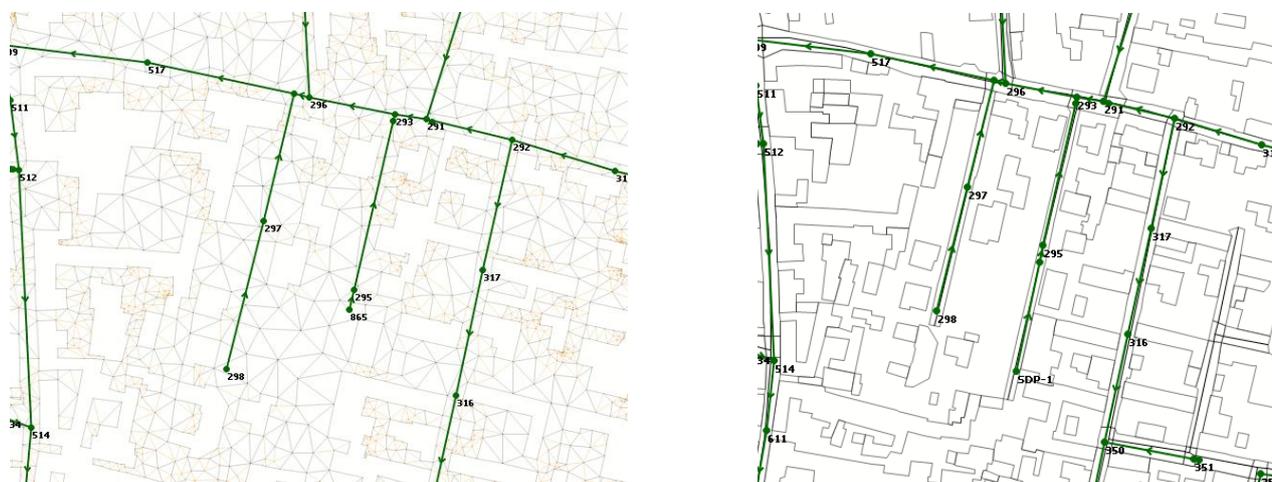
Planimetria stato di fatto (sx) e stato di progetto (dx) della tubazione di Vicolo San Paolo [IS03]
